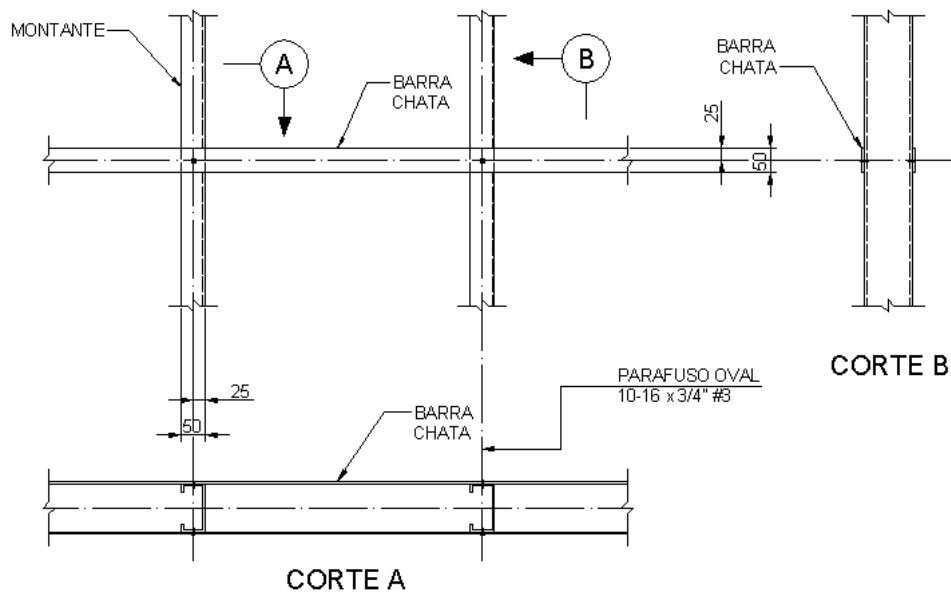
Detalhe construtivo da ligação Montante – Contraventamento horizontal [3]
